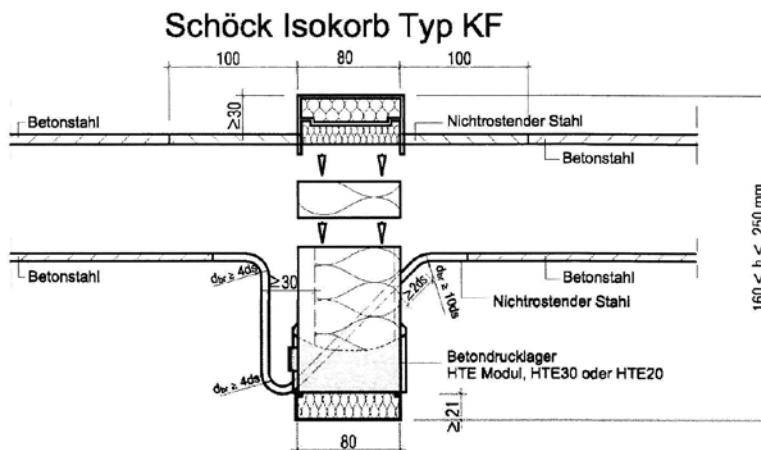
Schöck Isokorb Typ KF mit integrierter Aufhängebewehrung gem. Abschn. 3.3.1
